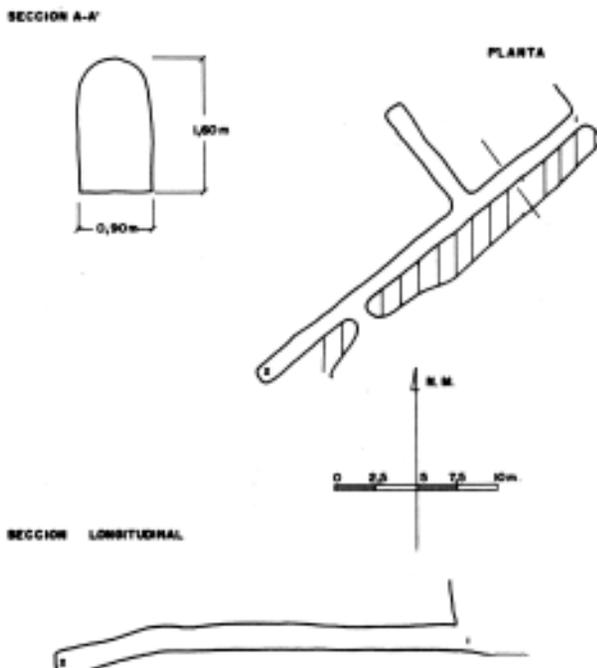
Plano de la galería romana 7 (planta y secciones).
